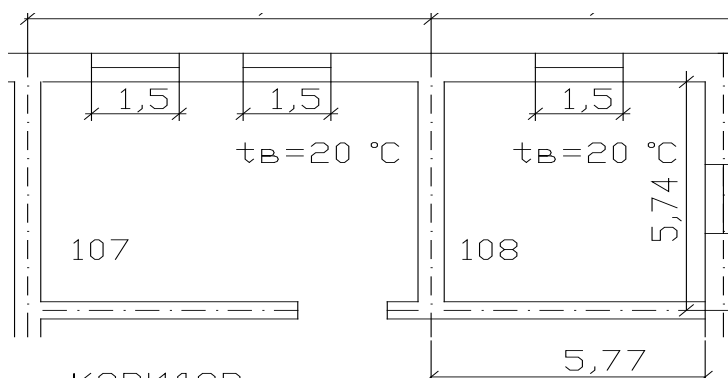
Фрагмент плана первого этажа офисного здания.
